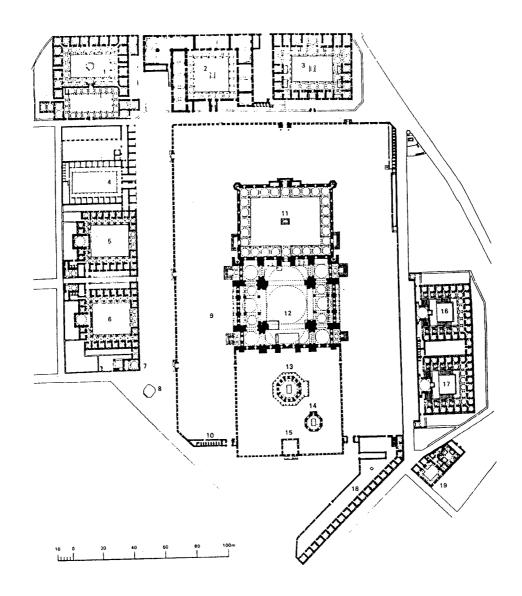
مسقط أفقي لجامع حسن بك في خير ابولو (عن: Kuran).
